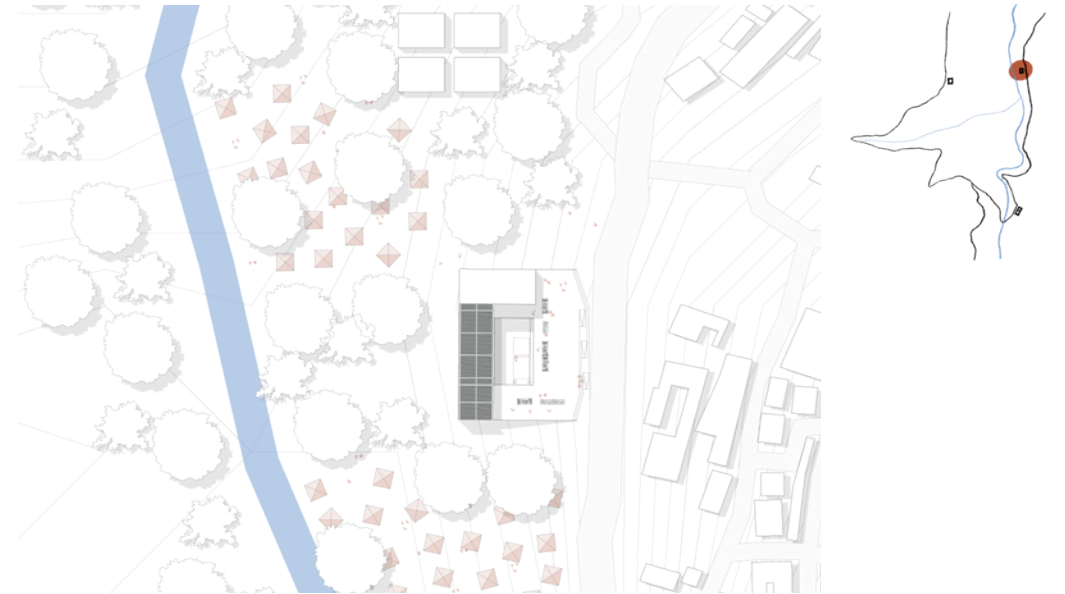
Plan masse Imzaine, crédit de l'auteur.
